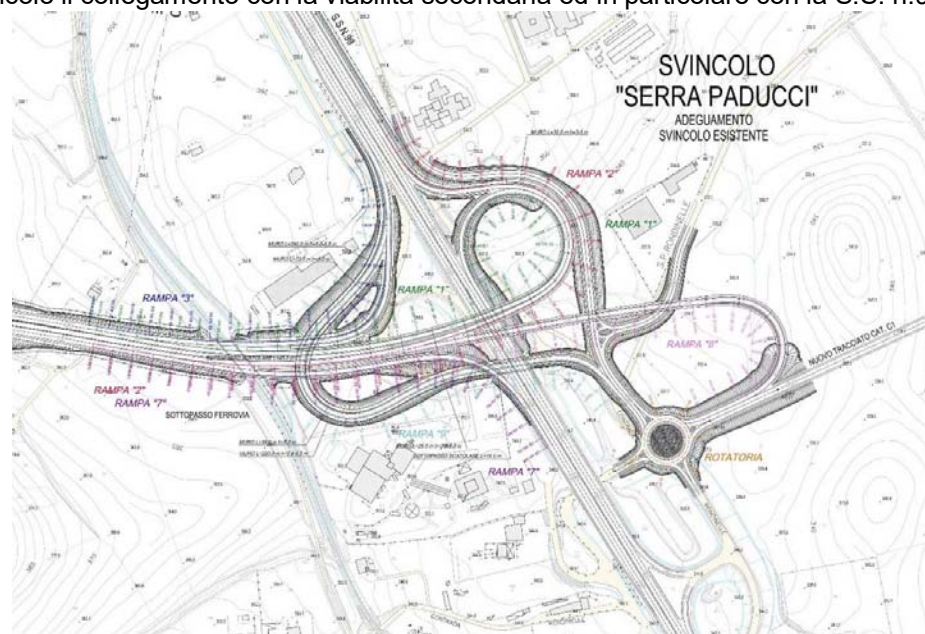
Planimetria Svincolo "Serra Paducci"
